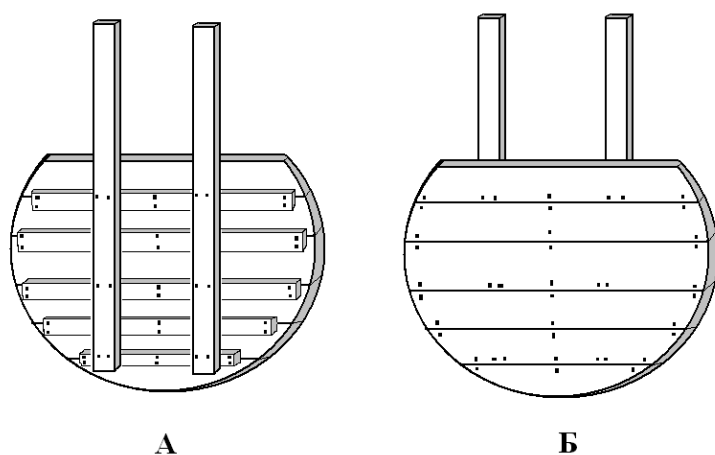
Деревянные щиты для частичного перекрытия стока воды через трубы бетонных переездов на торфополях урочища «Бублик»: А – внешняя сторона, Б – внутренняя, прилегающая к краям трубы.
